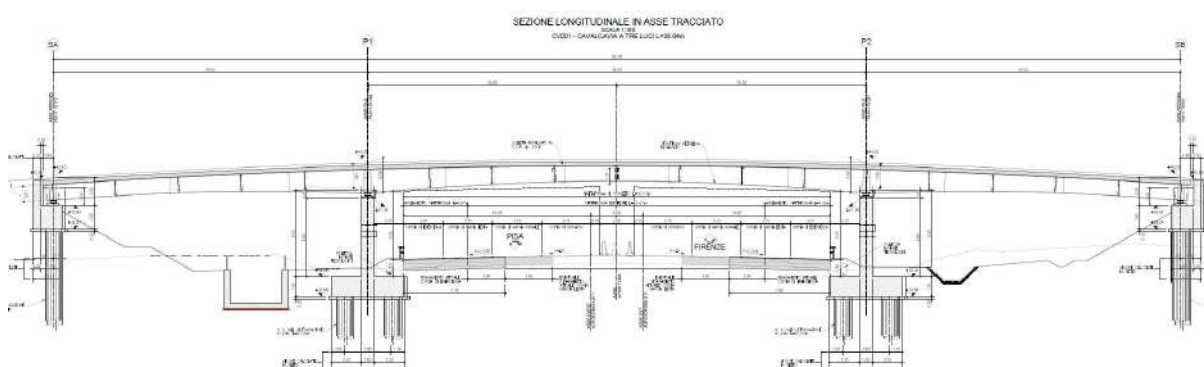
Sezione longitudinale cavalcavia a tre luci
